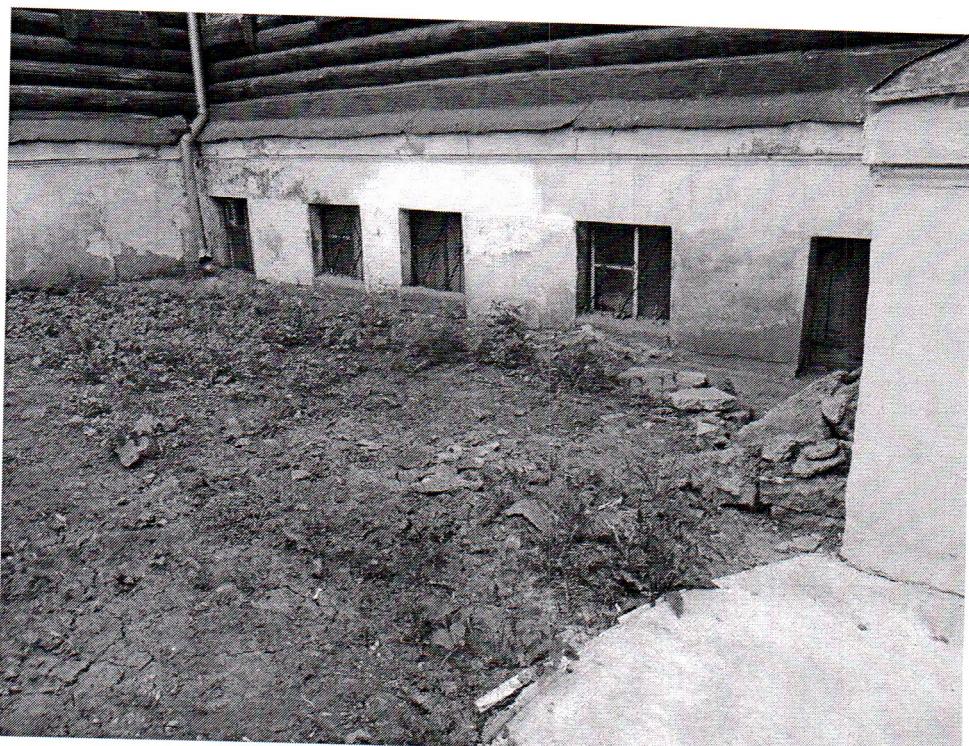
Отсутствует отмостка на северном фасаде. Уклон земельного участка в сторону здания.
